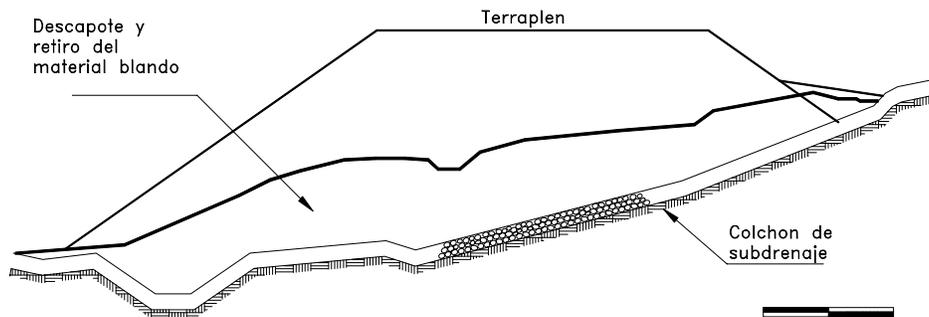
Diagrama de un colchón de drenaje colocado debajo de un terraplén.
